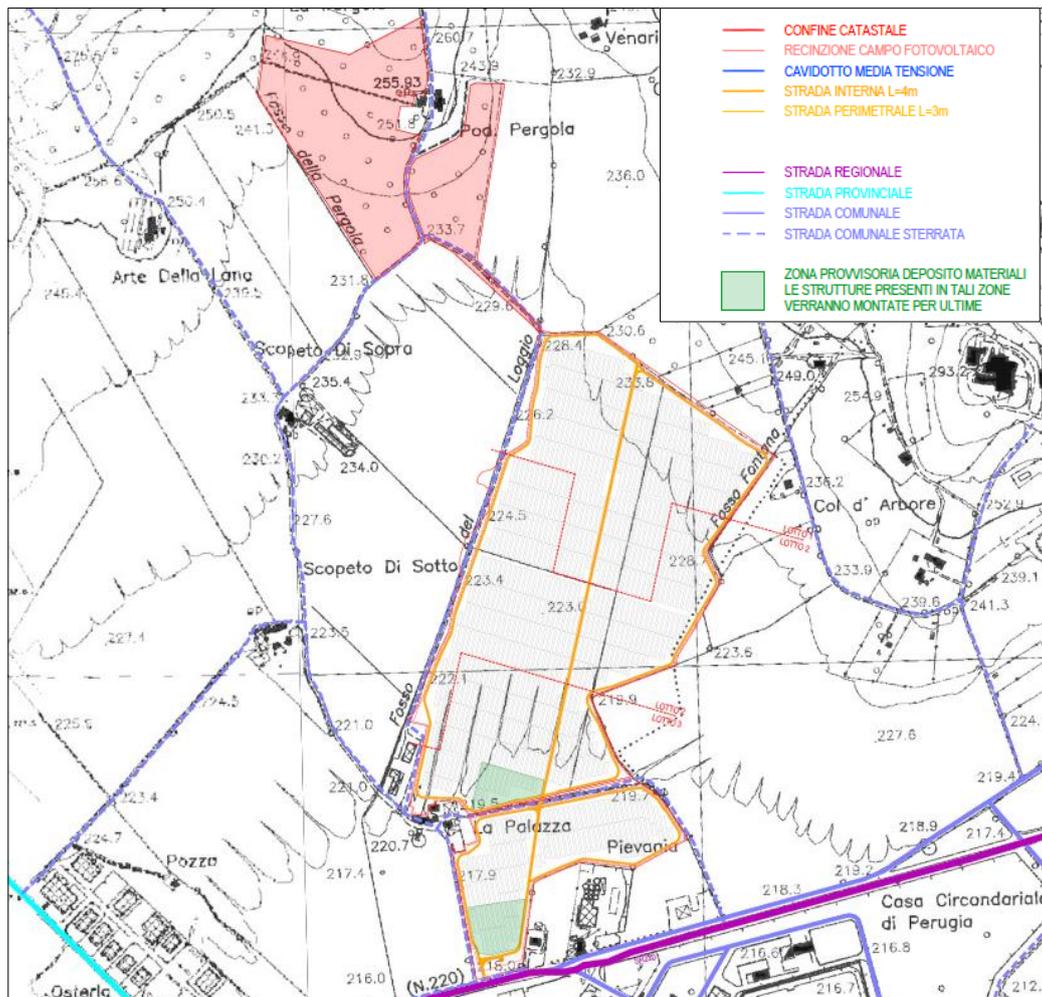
Ubicazione aree di cantiere dell'impianto
